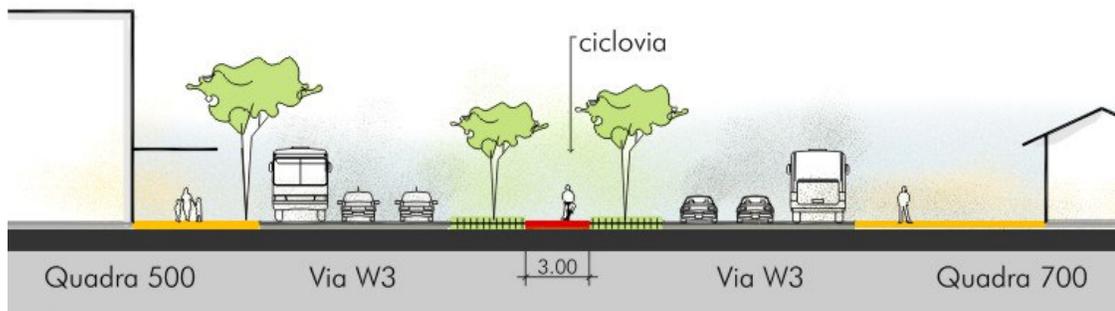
Ilustração da implantação de ciclovia no canteiro central da W3
